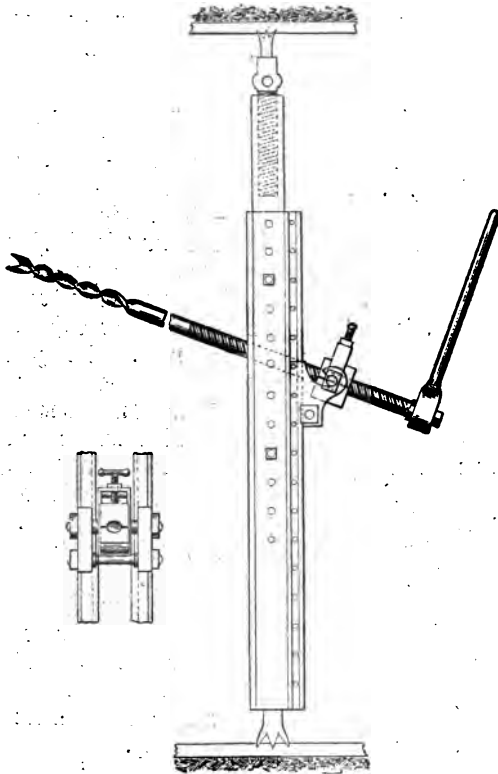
, 53. Lisbeth'sche Handbohrmaschine.
